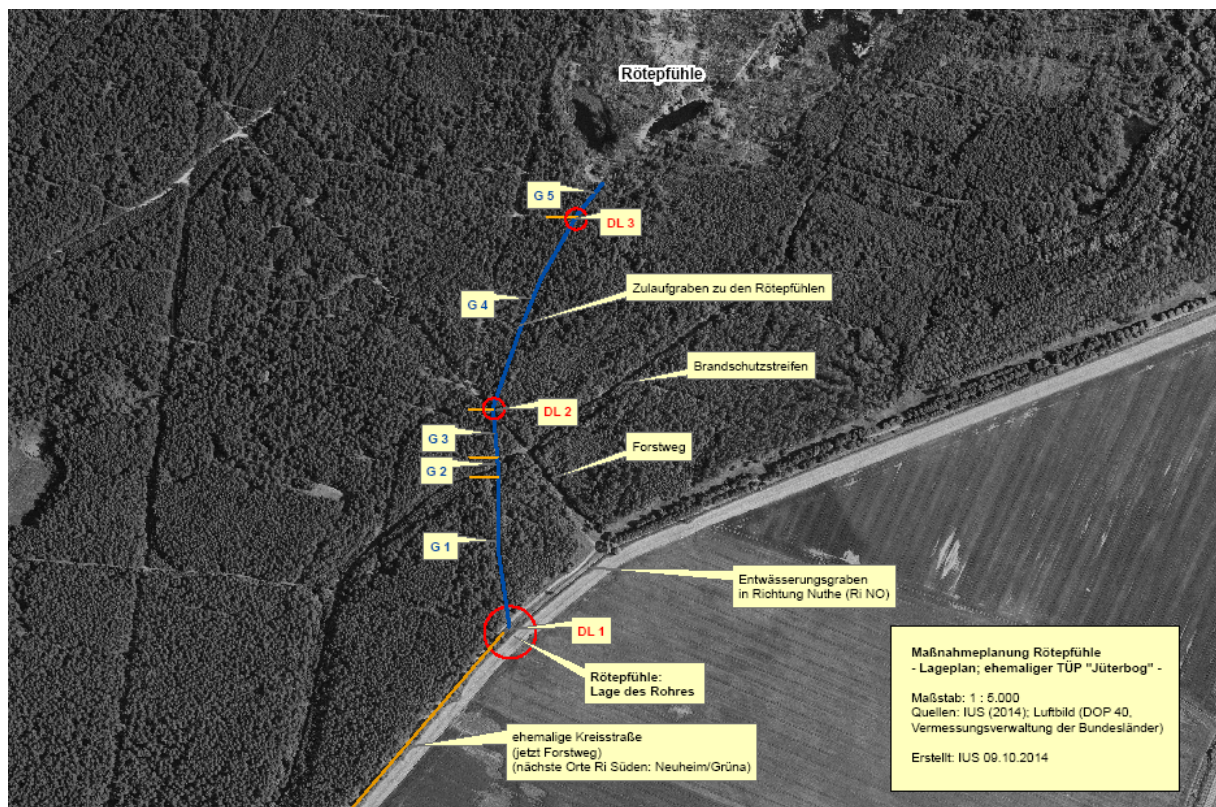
Entwurf Maßnahmenplanung Rötöpfühle, Lageplan, M 1:5.000 (IUS, 10/2014).
